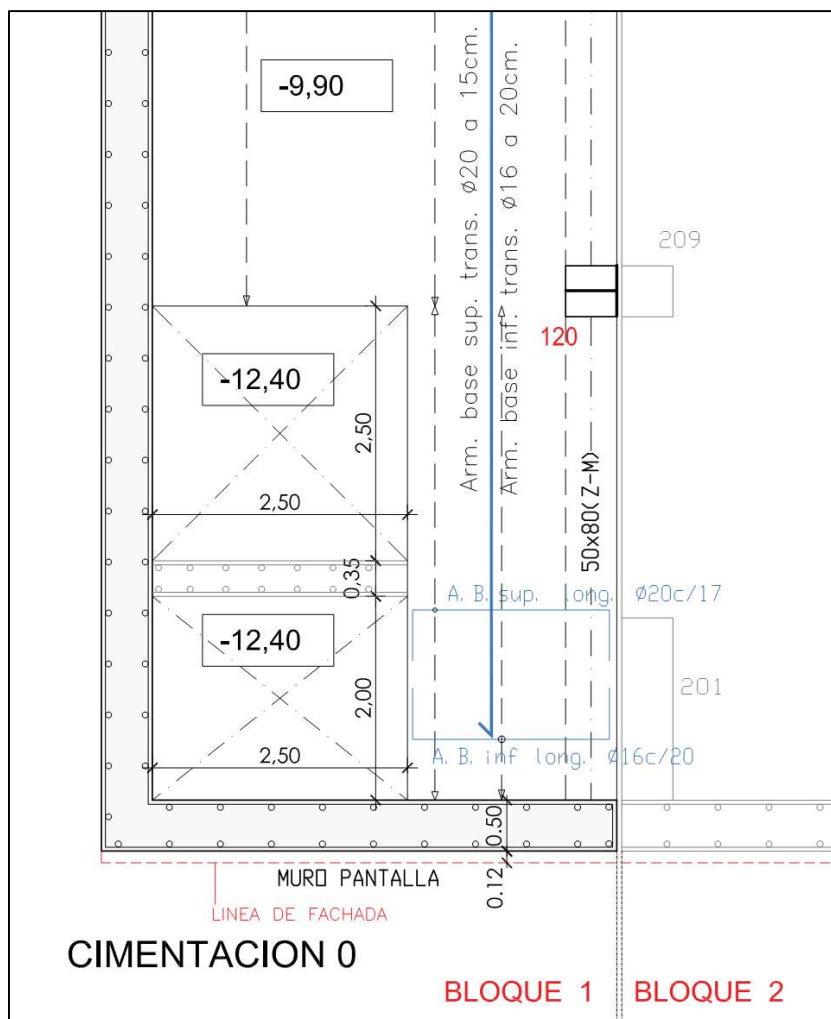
Detalle del replanteo en losa de cimentación del foso del ascensor.
